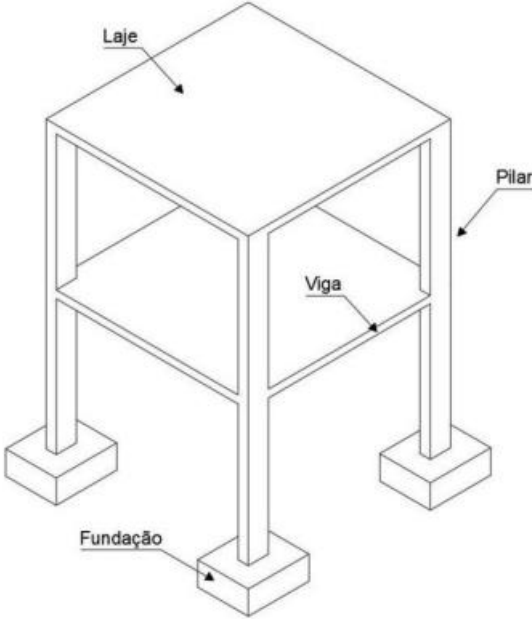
Elementos estruturais laje-viga-pilar (Fonte: BARBOSA, 2019)
